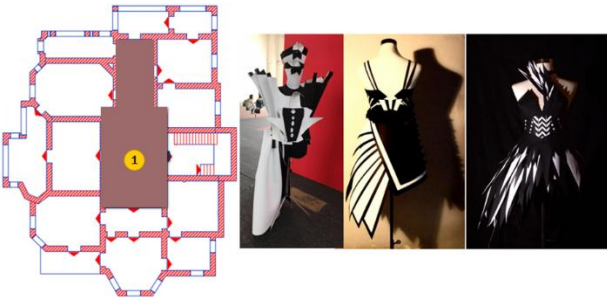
المسقط الأفقي للدور الأول لتوجيه الزائرين للدخول من السلم موراً بالحيزات الداخلية.
